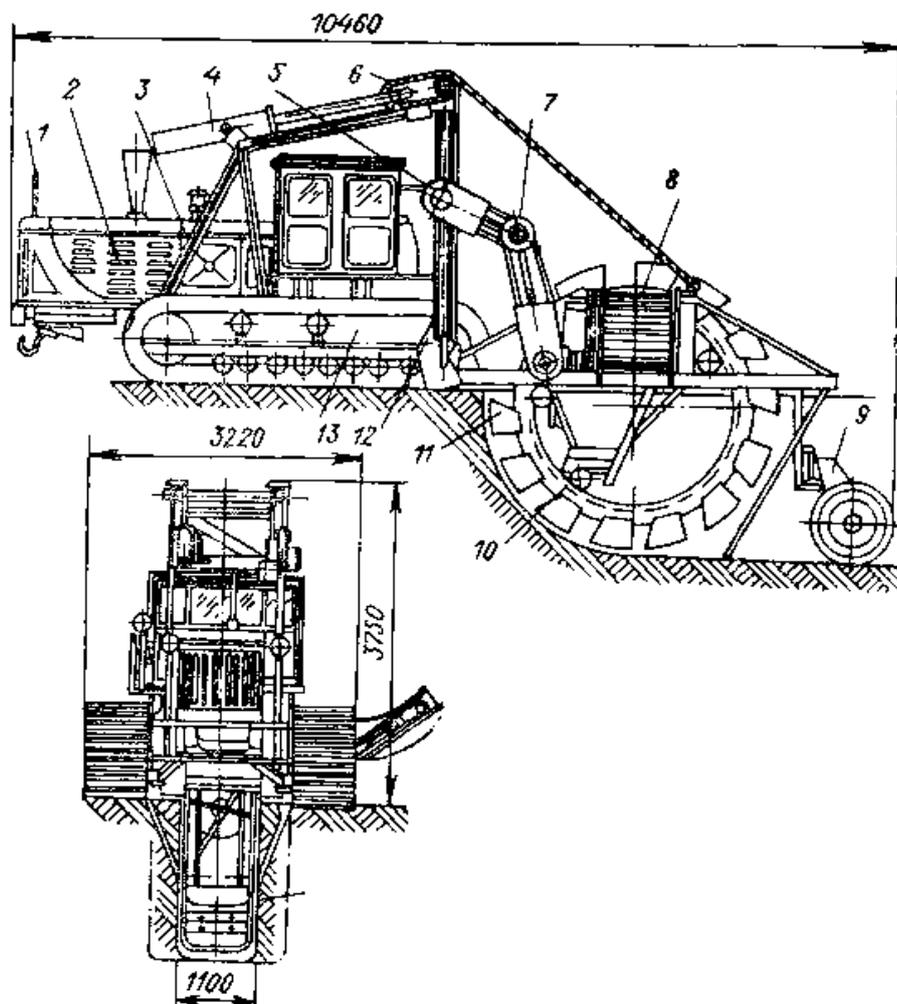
Общий вид роторного экскаватора ЭР-7АМ:
